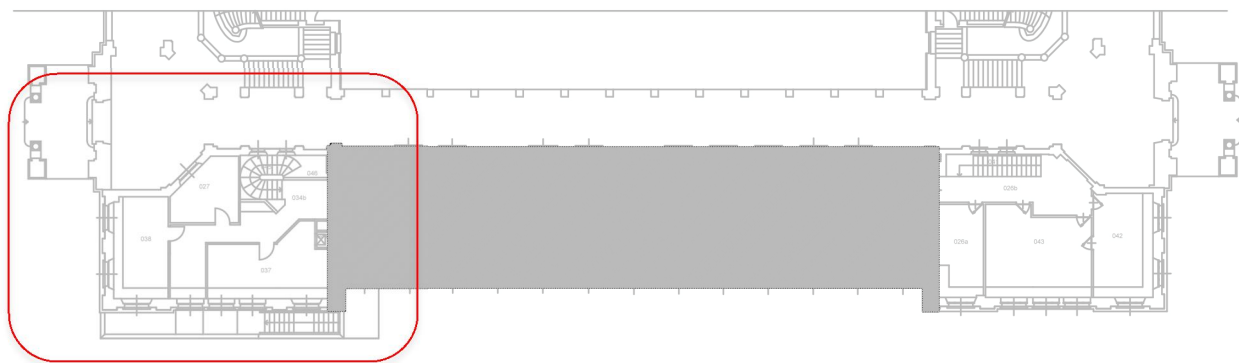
Ritaglio Pianta Piano Soppalco edificio 2 con segnalazione della zona interessata dal rilievo
